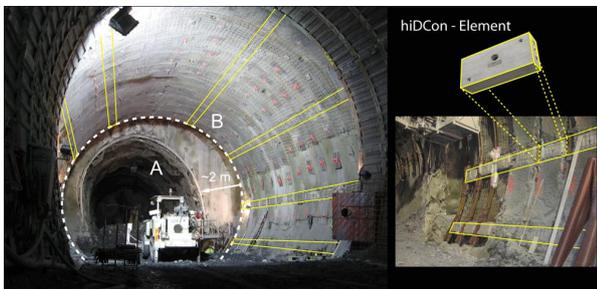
Zugangstollen St. Martin la Porte, Lyon-Turin Ferroviaire: Konvergenzen bis zu 2 m (Profil A), Reprofilierung mit dem Einbau hochdeformierbarer Betonelemente (Profil B)
